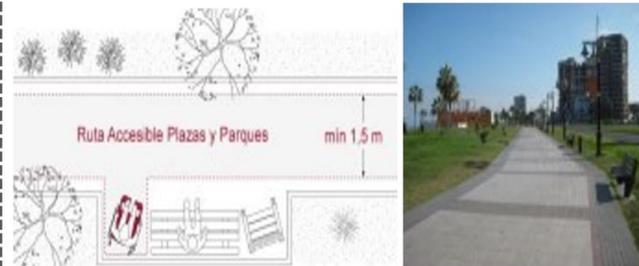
Rutas accesibles en plazas y parques de ancho mínimo 1,5m. Foto 3 (der): Ruta accesible de pavimento estable en parque.
